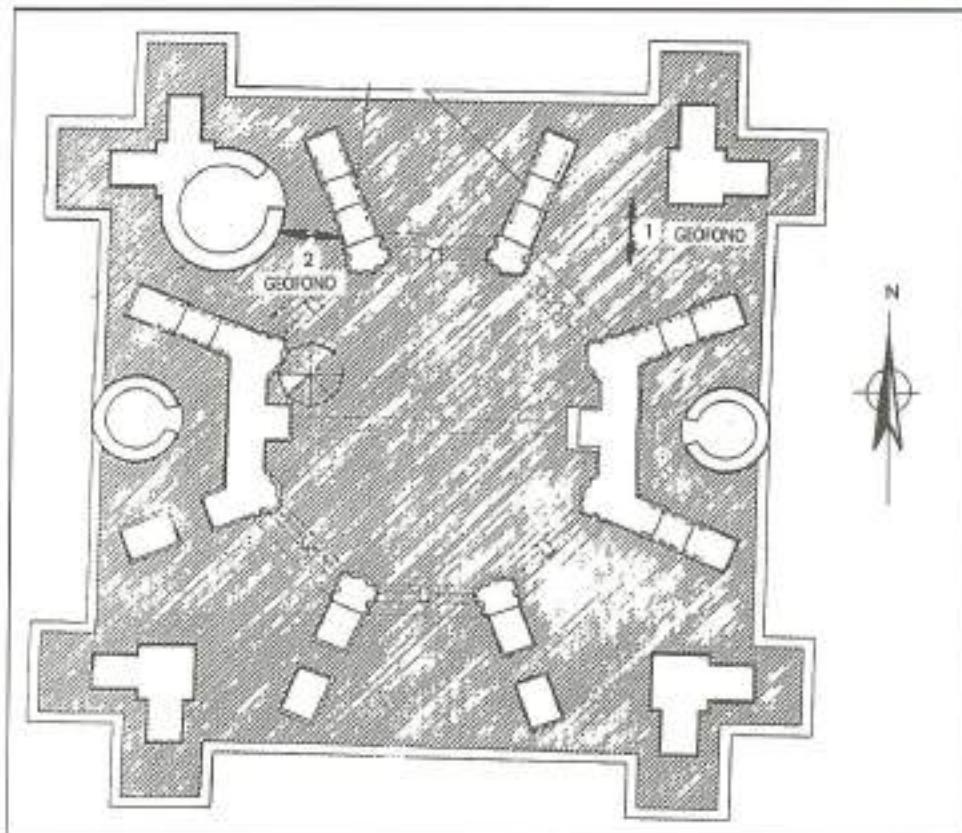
Situación en planta de los geófonos utilizados para captar las vibraciones.
